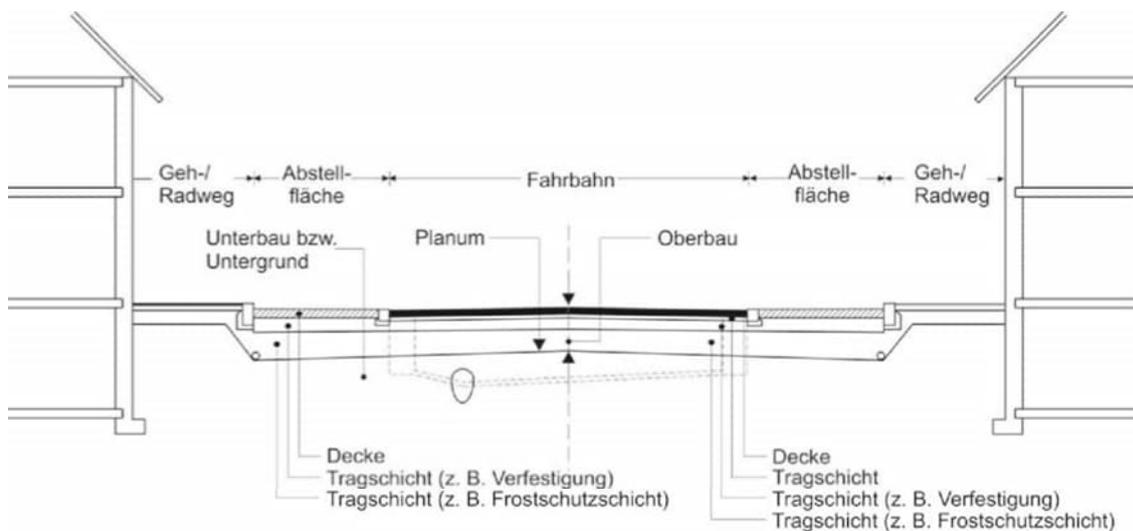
Beispielhafter Aufbau einer Befestigung in geschlossener Ortslage mit wasserundurchlässigen Randbereichen und geschlossener seitlicher Bebauung sowie mit Entwässerungseinrichtungen
